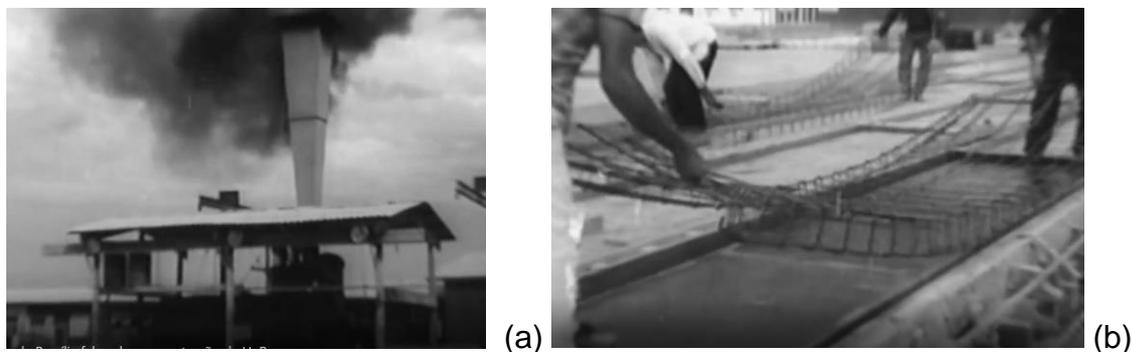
Construção do CEPLAN (a) Usina de fabricação dos elementos pré-moldados (b) Locação das armações dos painéis nas fôrmas de madeira compensada
